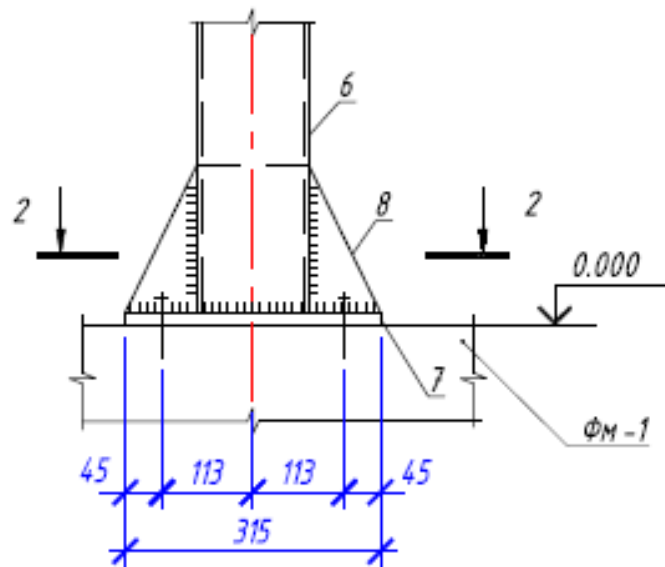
Запропоноване конструктивне вирішення вузла опирання вертикальної стійки (база стійки) на стовпчатий монолітний залізобетонний фундамент (вид спереду).
